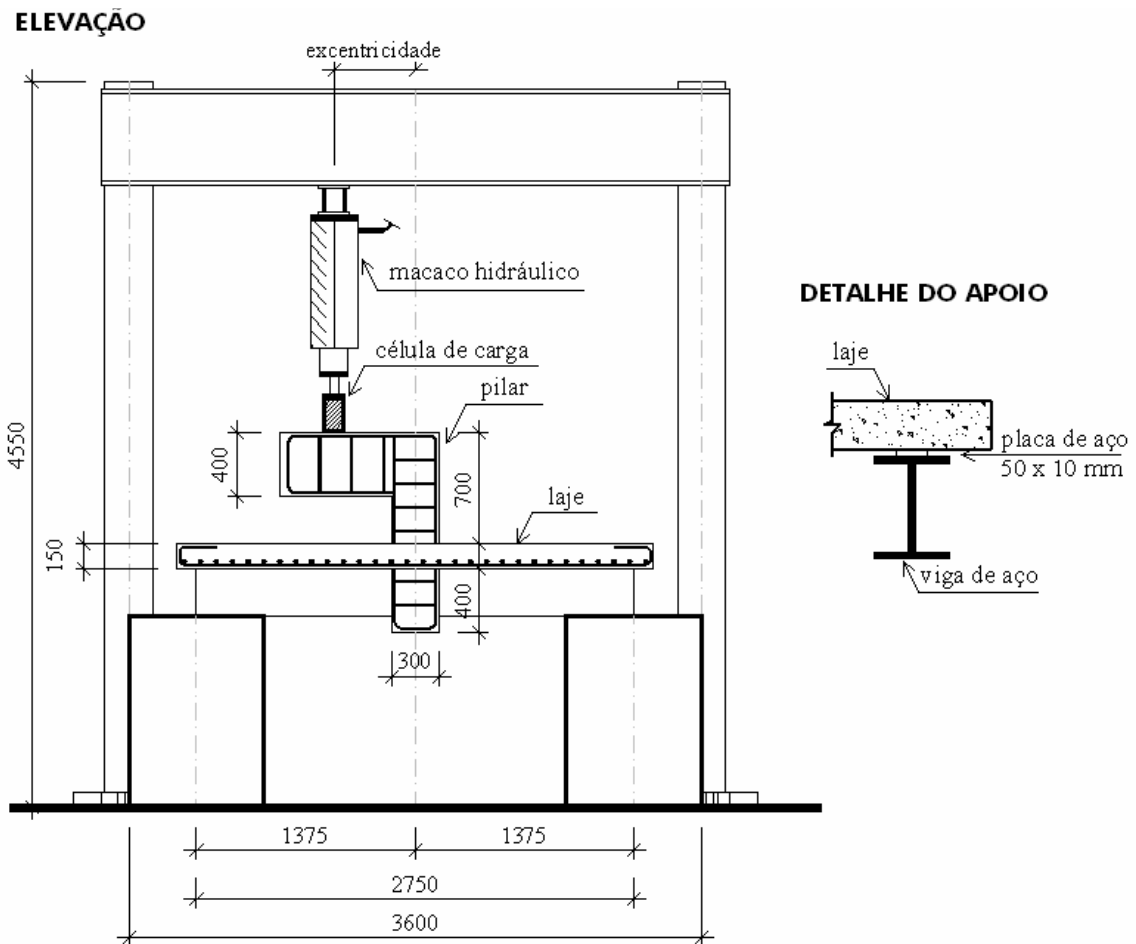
Sistema de ensaio das lajes de Krüger *et al.* - Elevação (2000)
